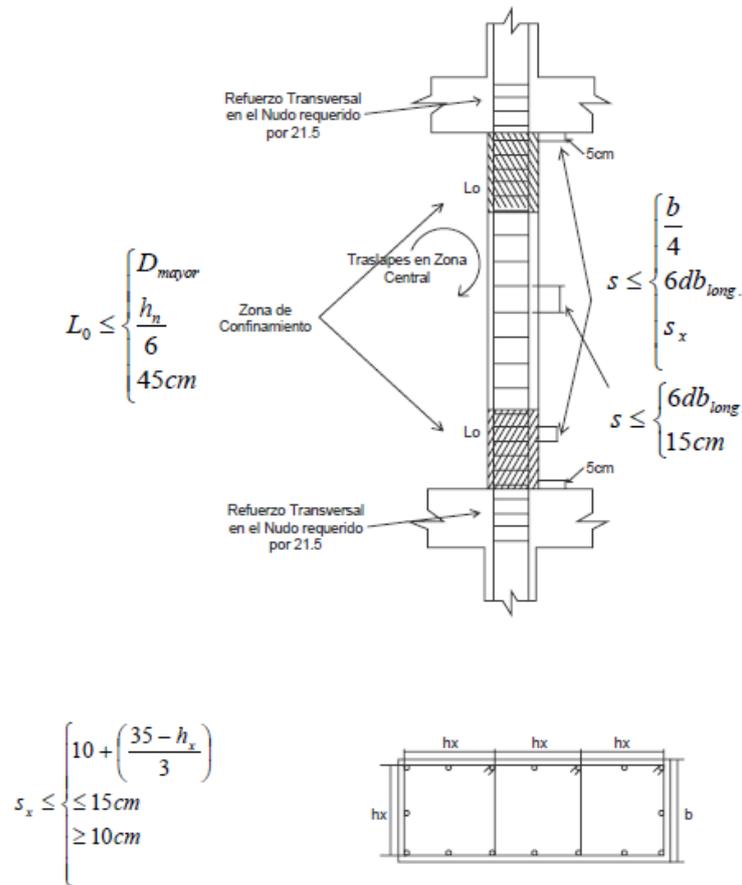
REFUERZO TRANSVERSAL DE COLUMNAS
